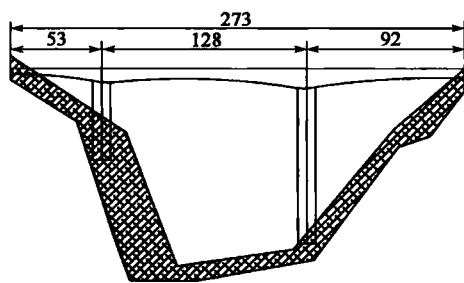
岩头河大桥总体布置图(尺寸单位:m)
